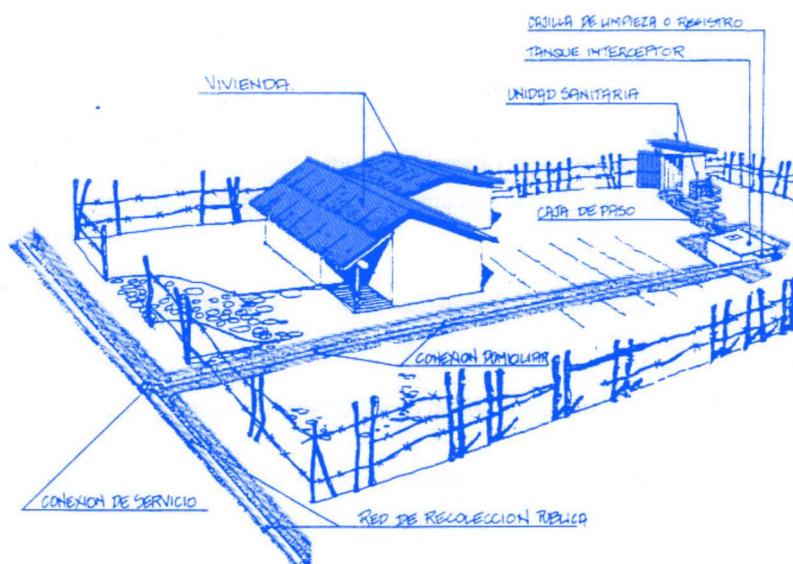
Esquema general de un Alcantarillado de Flujo Decantado
